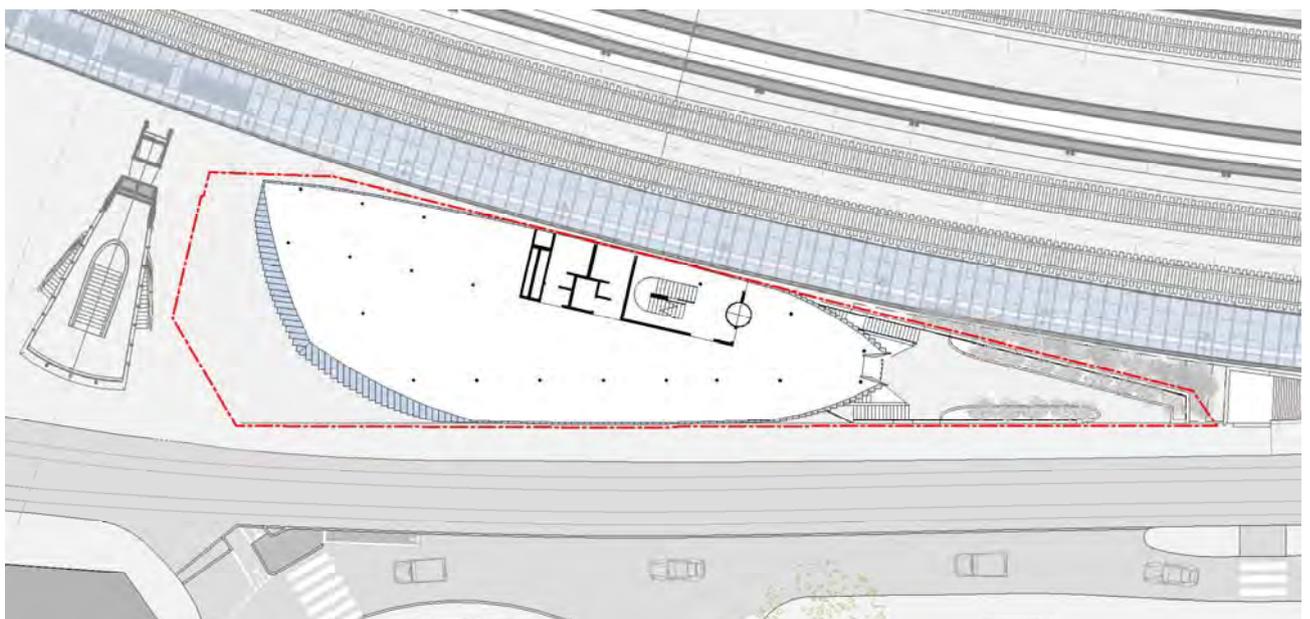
Grundriss Geschoss 1 mit dem Aussenbereich 2 im östlichen Teil des Grundstücks gemäss Richtprojekt „Haus zum Falken“ (Quelle: Calatrava Valls SA, Dezember 2015)
